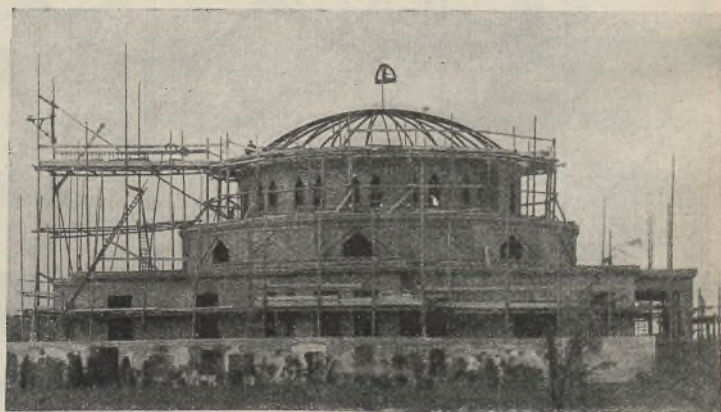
Predigthalle in Hannover. Ansicht der fertig verlegten Konstruktion.
